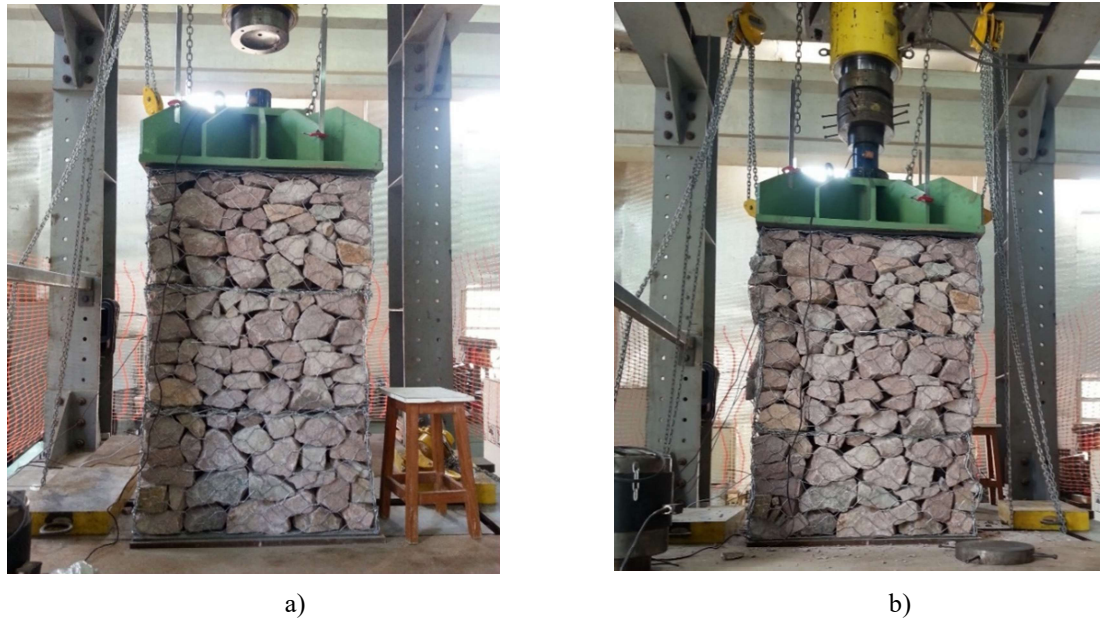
Teste 2 - compressão em três caixas de gabião, uma sobre a outra, malha tipo 8x10, diâmetro 2,7mm: a) início do ensaio; b) final do ensaio.
